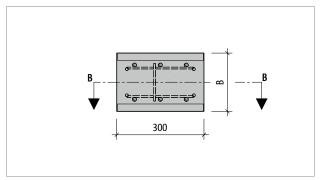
Schöck Sconnex® type W-T2: projection horizontale du produit
